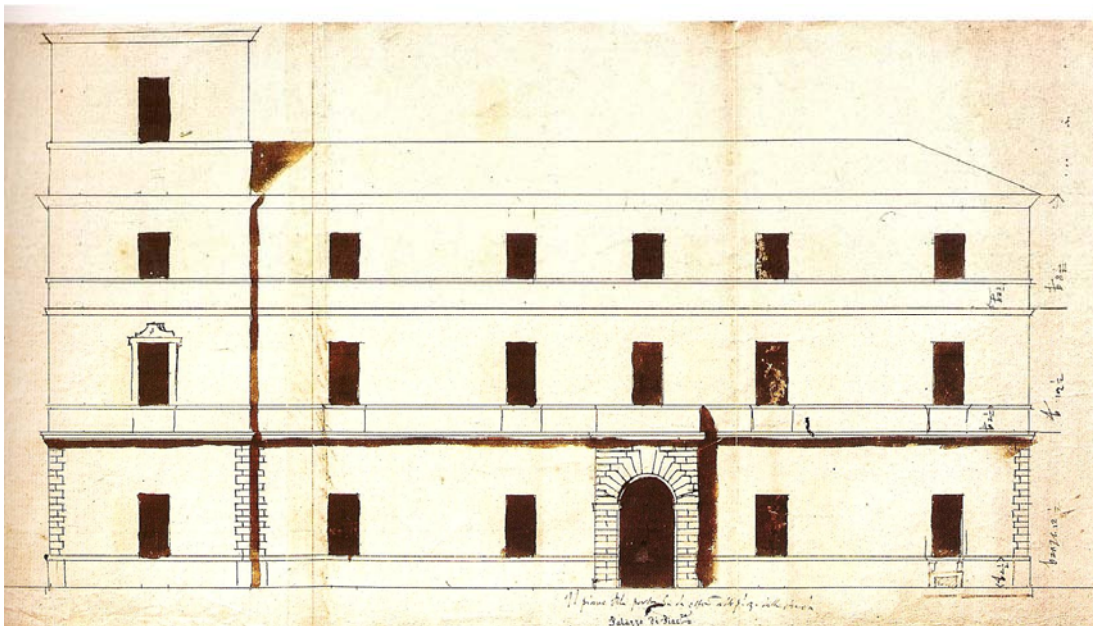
Jacopo Barozzi da Vignola, progetto per la facciata di Palazzo Radini Tedeschi a Piacenza. Collezione privata (da B. Adorni 2008 (a), p.141).
